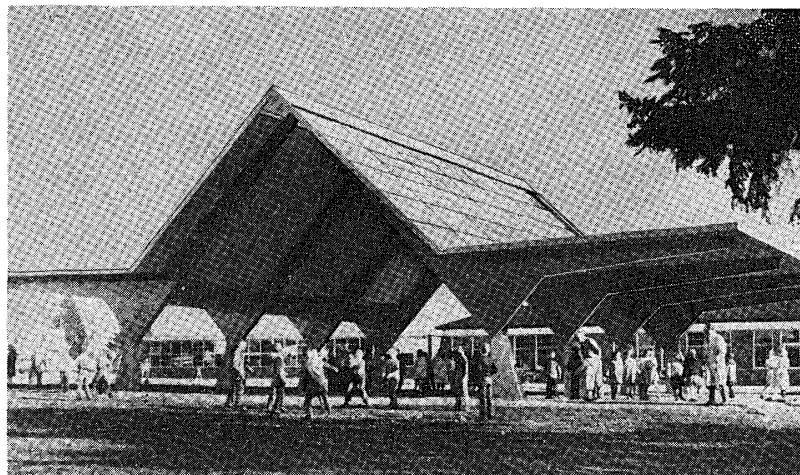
Washington 州(米)の学校にたてられた play shelter (Wood, 28, 134, (1963))
